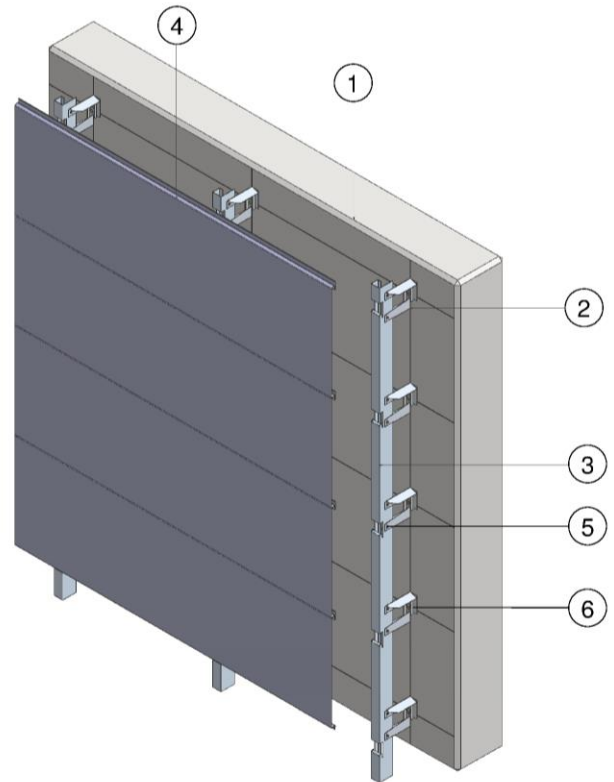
Beispiel für Befestigung auf Mauerwerk bzw. Fertigbetonteilen
